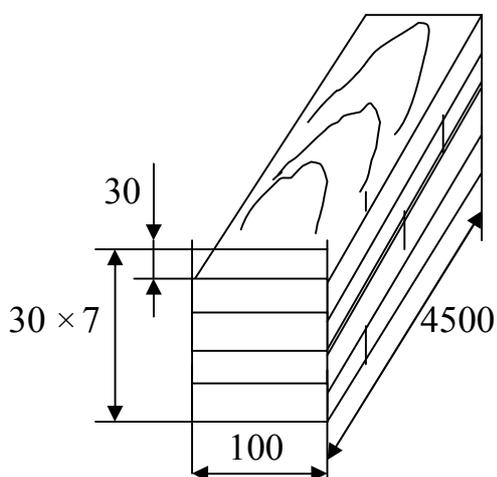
Схема клееной слоистой балки из пиломатериалов
